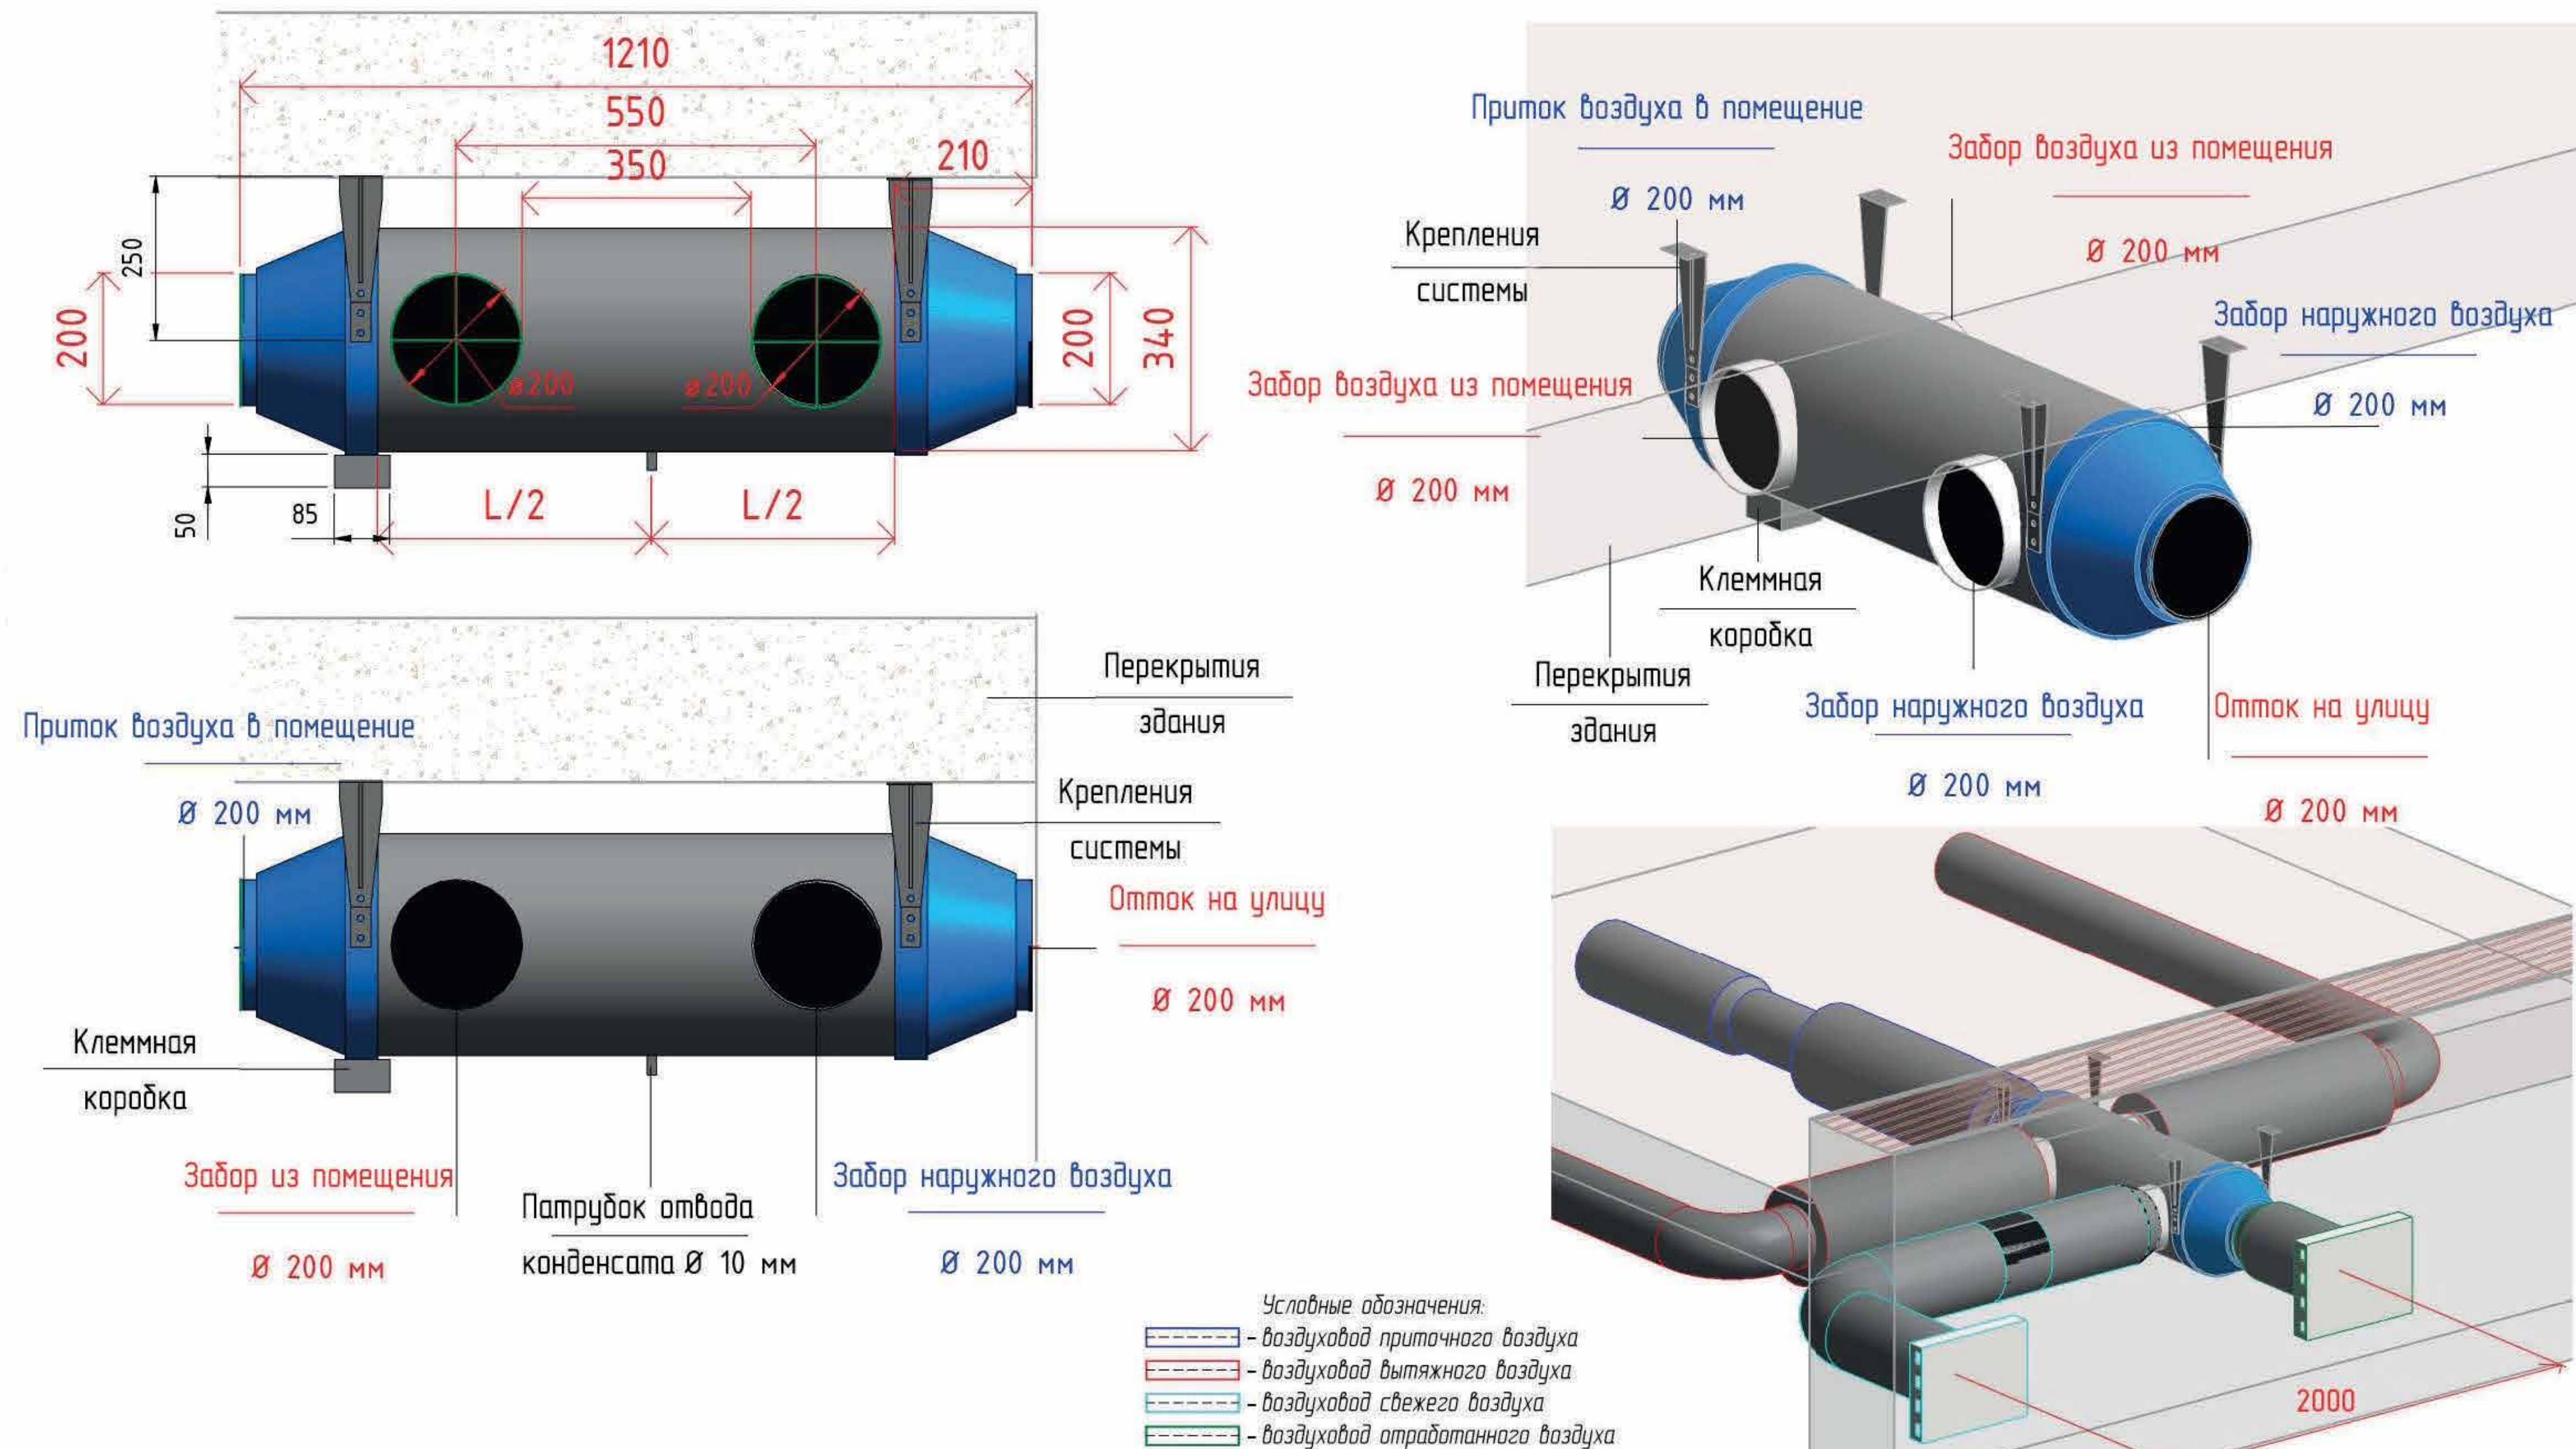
Вид сверху. Канальная система вентиляции PRANA-340S №1 расположена в помещении под потолком
